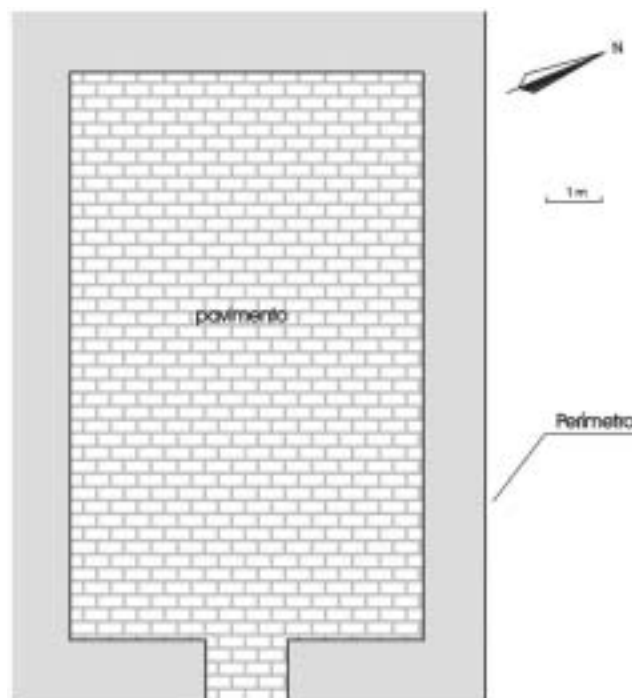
Reconstrucción hipotética de la planta del Edificio I de Santa Eulalia de Bóveda
